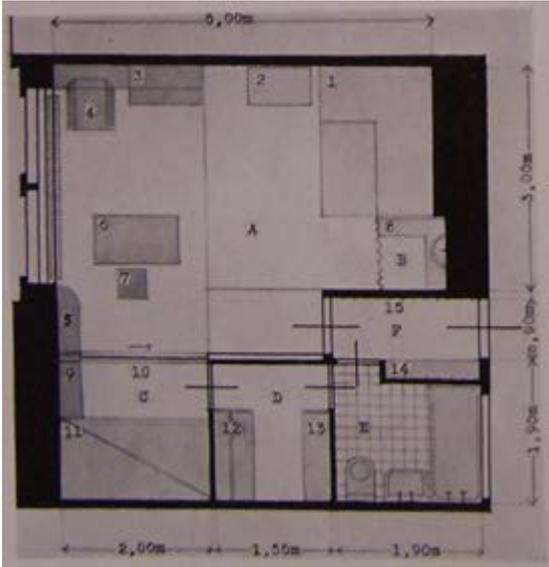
Grundriss, Wohnung Breslauer, Zeitschrift „Die Bau- und Werkkunst“, 1932.
